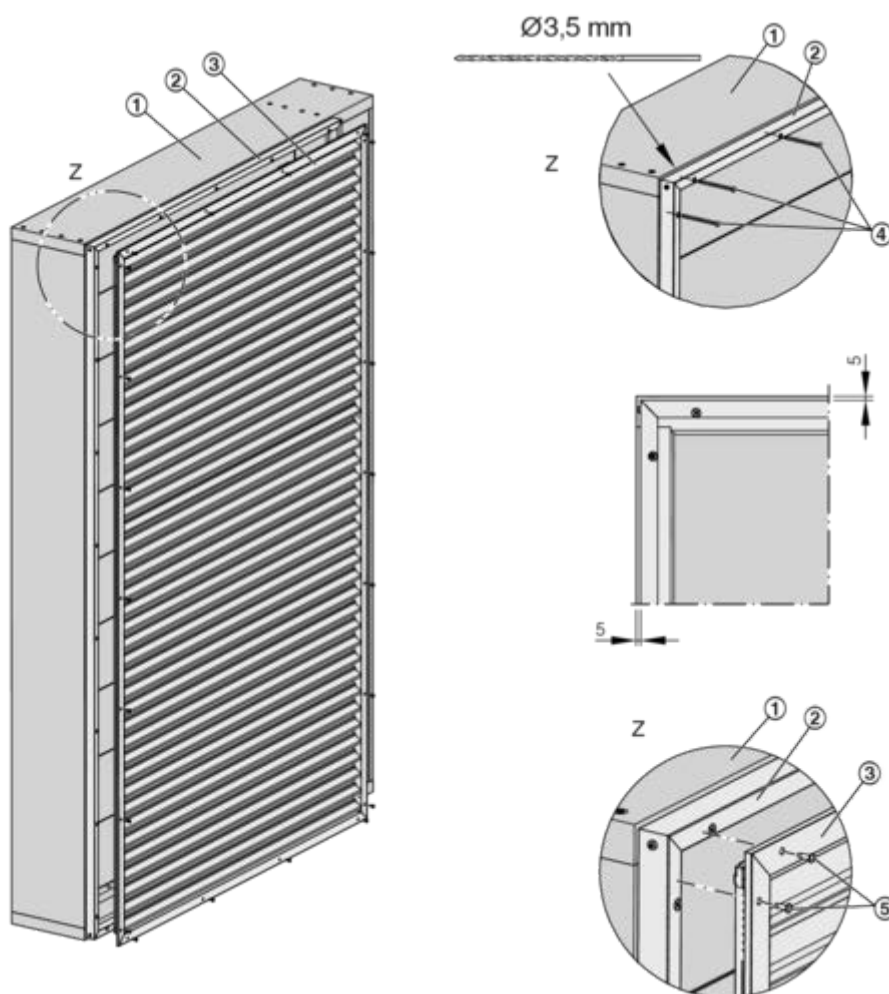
Montare grilă din aluminiu cu lamele înclinate pe EK-JZ
